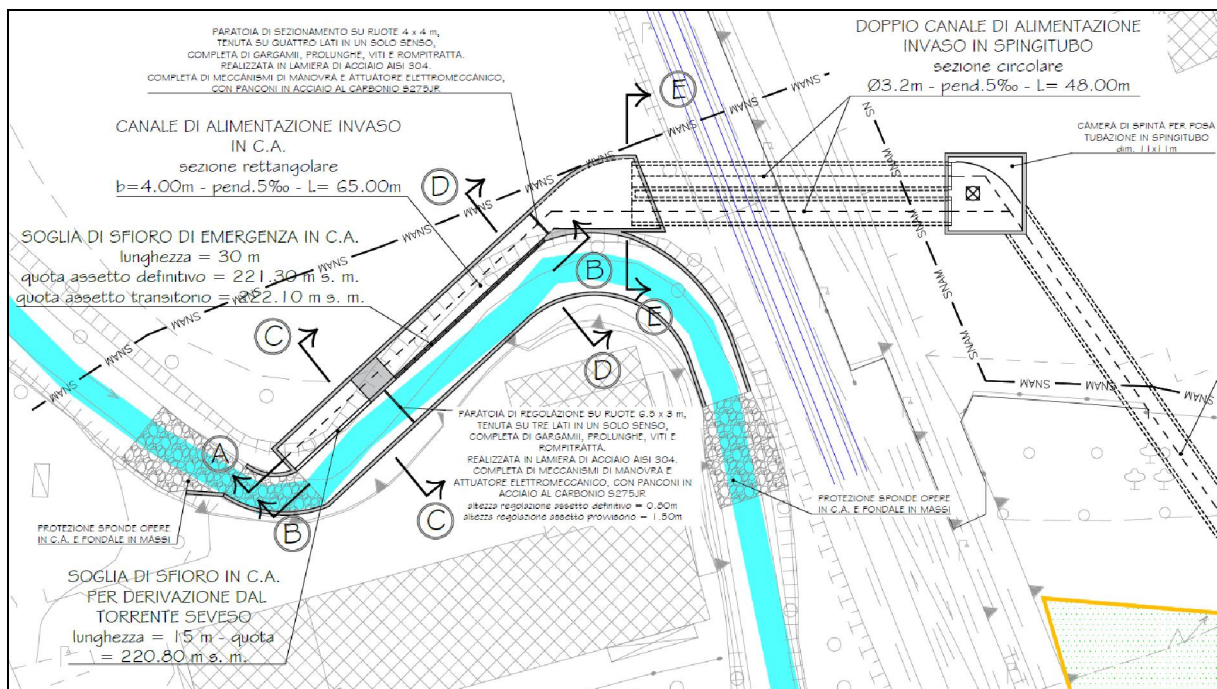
Planimetria di progetto dell'opera di presa dal T. Seveso
